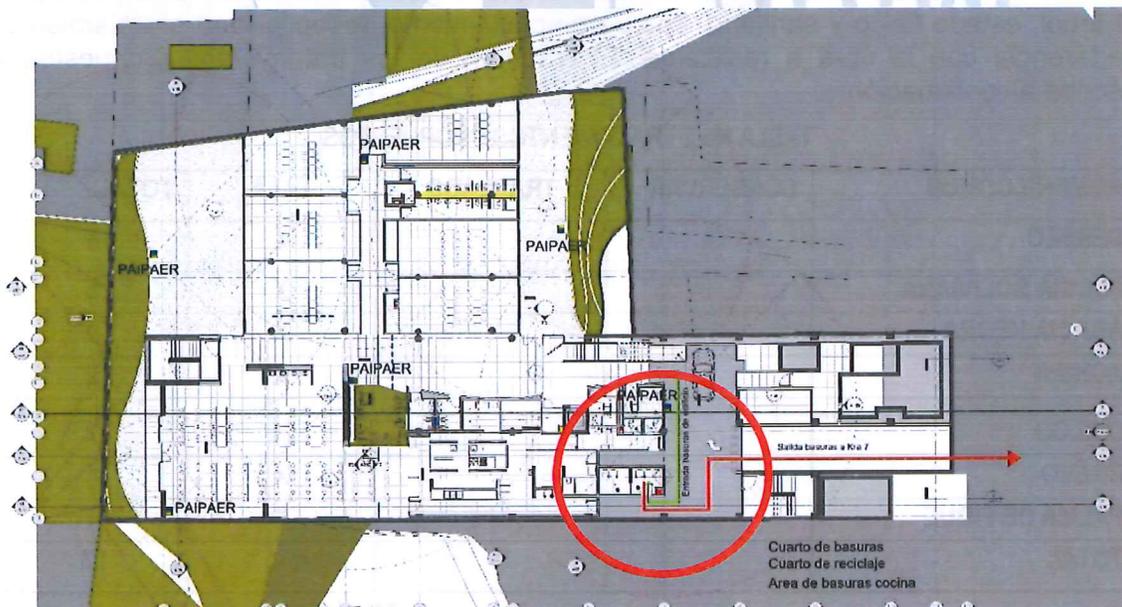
Imagen de planta nivel -3.65 – localización de cuarto de residuos (anexo No. 6).
